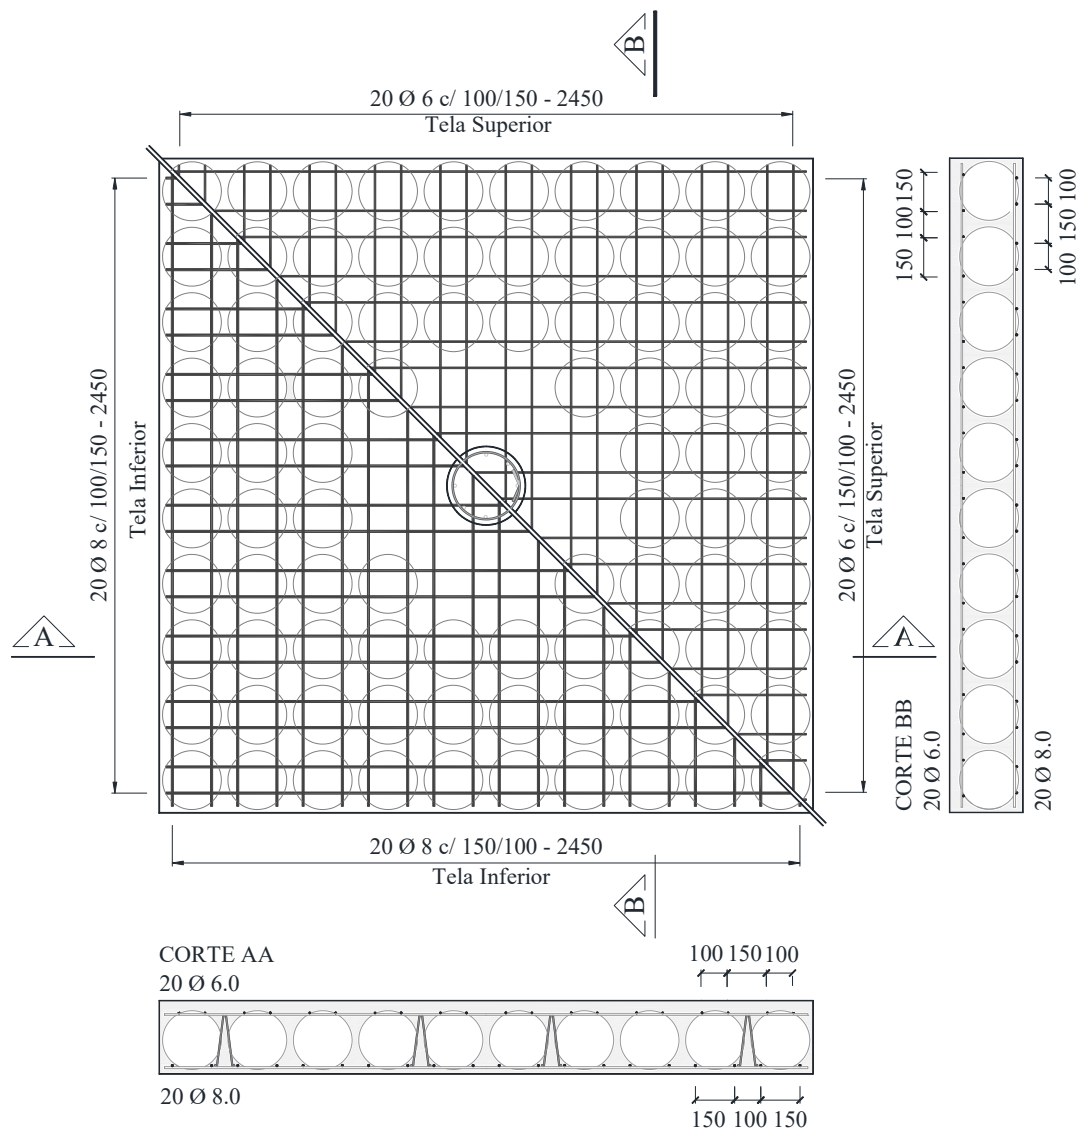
Tela inferior e superior para lajes sem pré-laje
